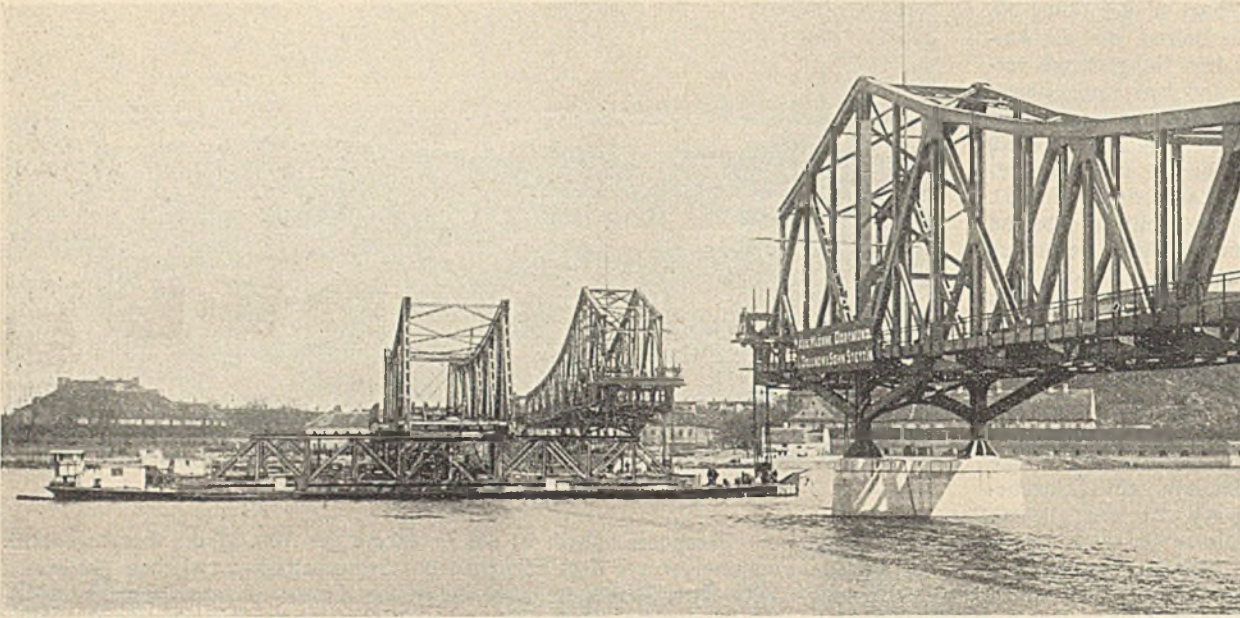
Der Koppelträger unmittelbar vor dem Quereinschwimmen.
